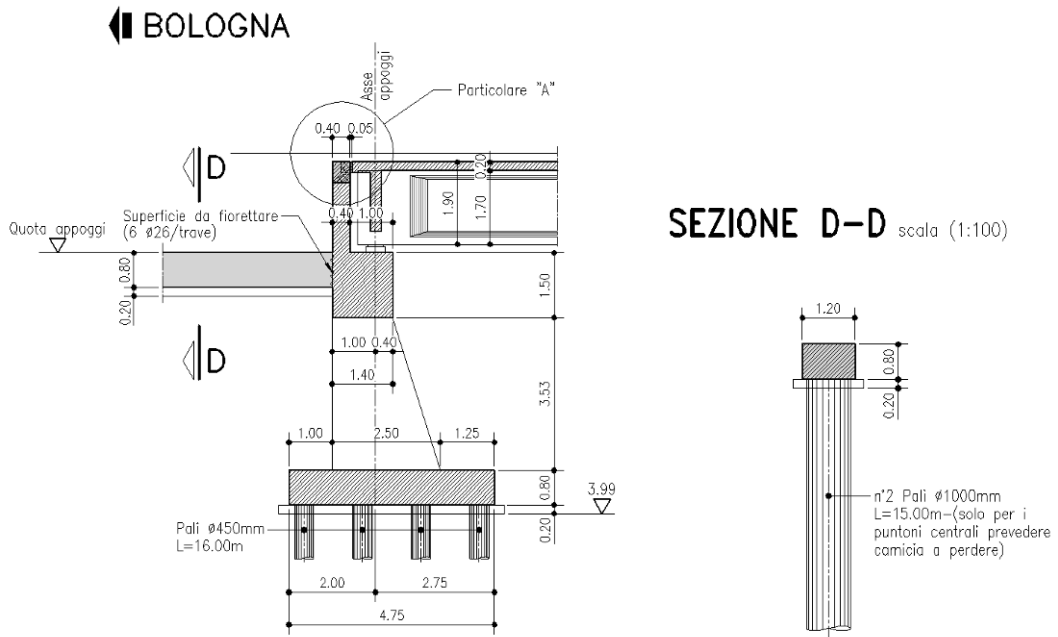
Dettagli tiranti a tergo spalla
